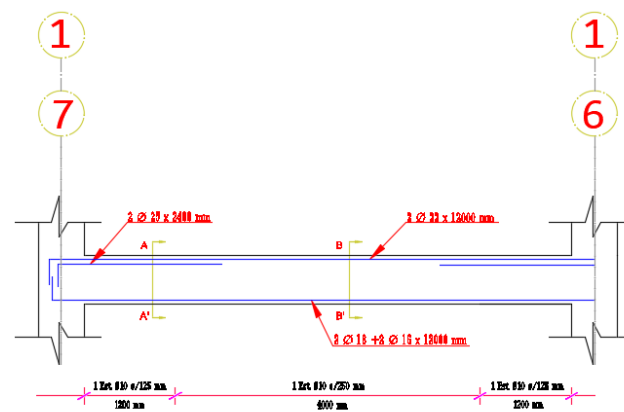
Detalle de viga principal eje "Y" piso 1-2-3.
